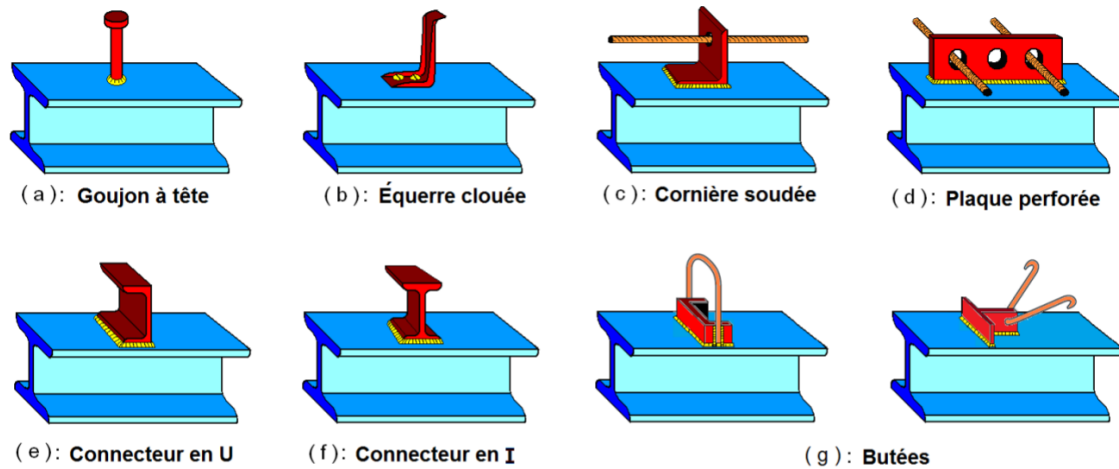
Types de connecteurs utilisés dans les poutres mixtes
